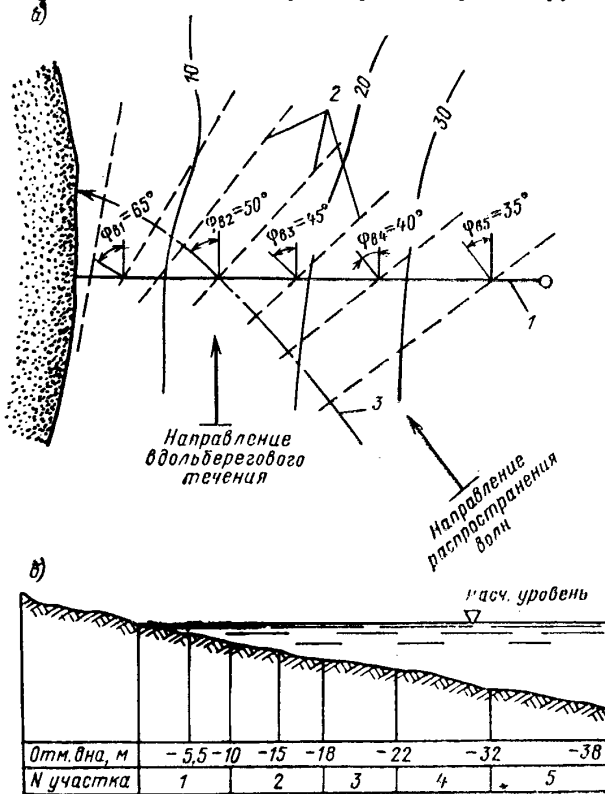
К примеру 15 расчета нагрузок на подводный трубопровод
